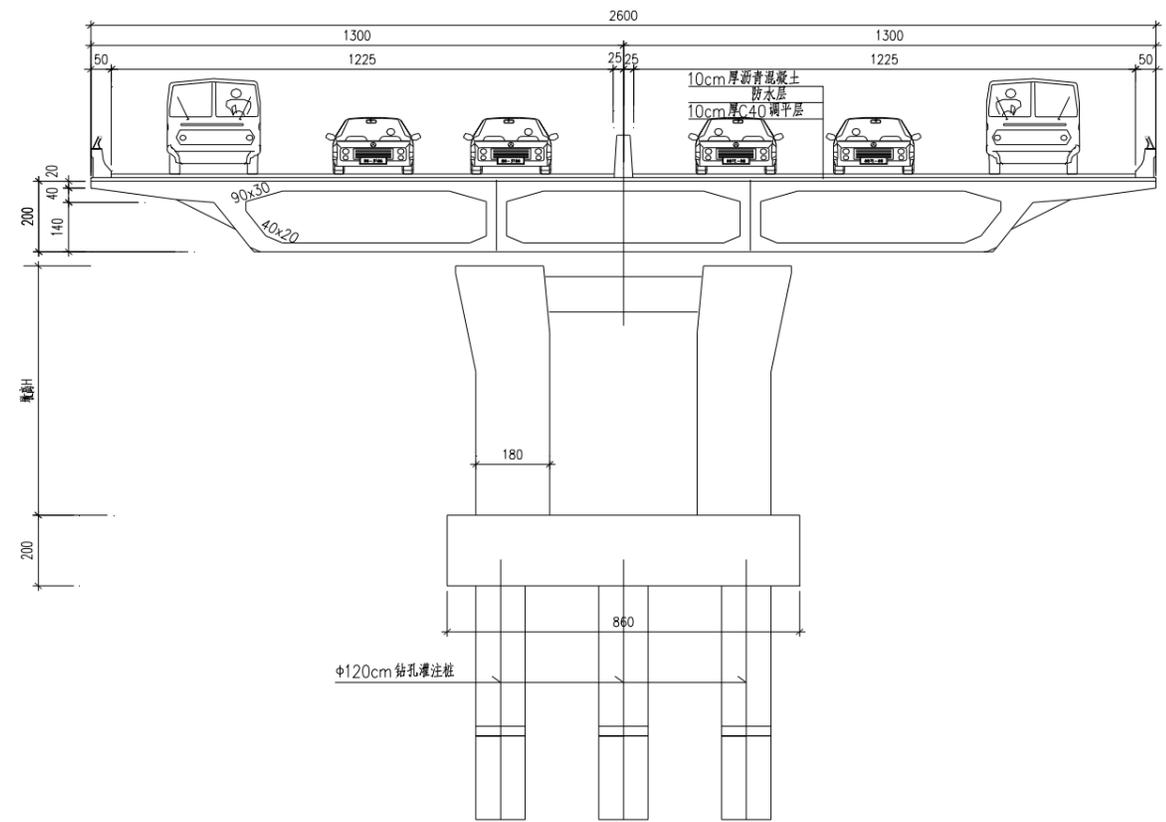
高架断面示意图（预应力钢筋混凝土箱梁）（尺寸单位：cm）
